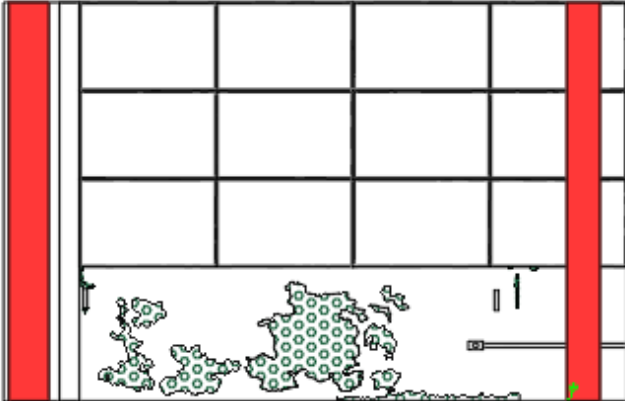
FIDs do primeiro pavimento (P1) (continuação)
